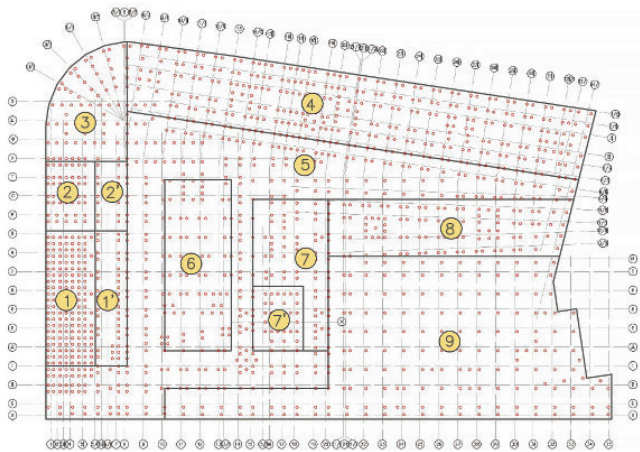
Схема фундамента с участками с одинаковыми нагрузками и расстановкой свай
